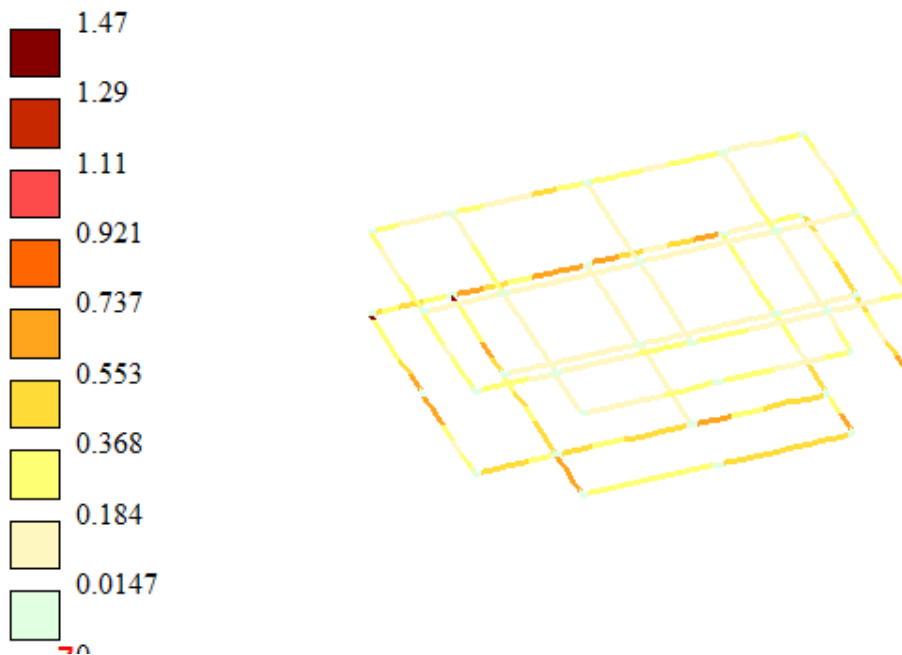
Схема суммарной площади армирования поперечной сечение балки
